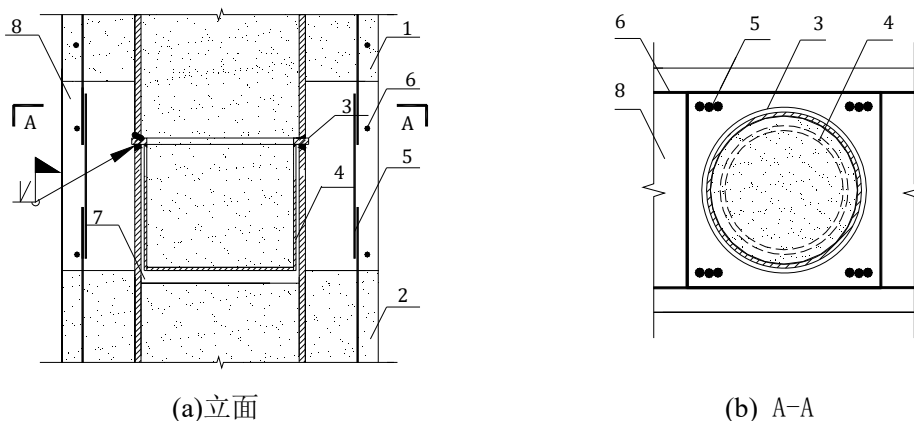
排钢管构件上下拼接连接示意 1——钢管内插座浆
